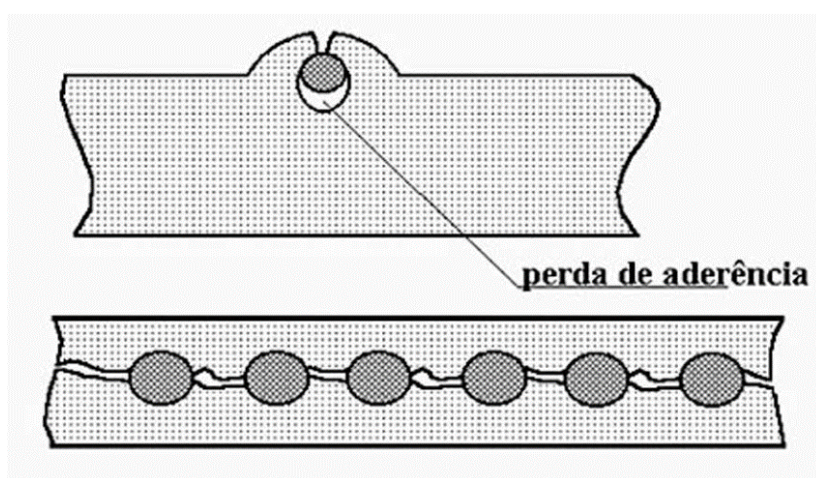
Viga sujeita a quadros de fissuração diversos
